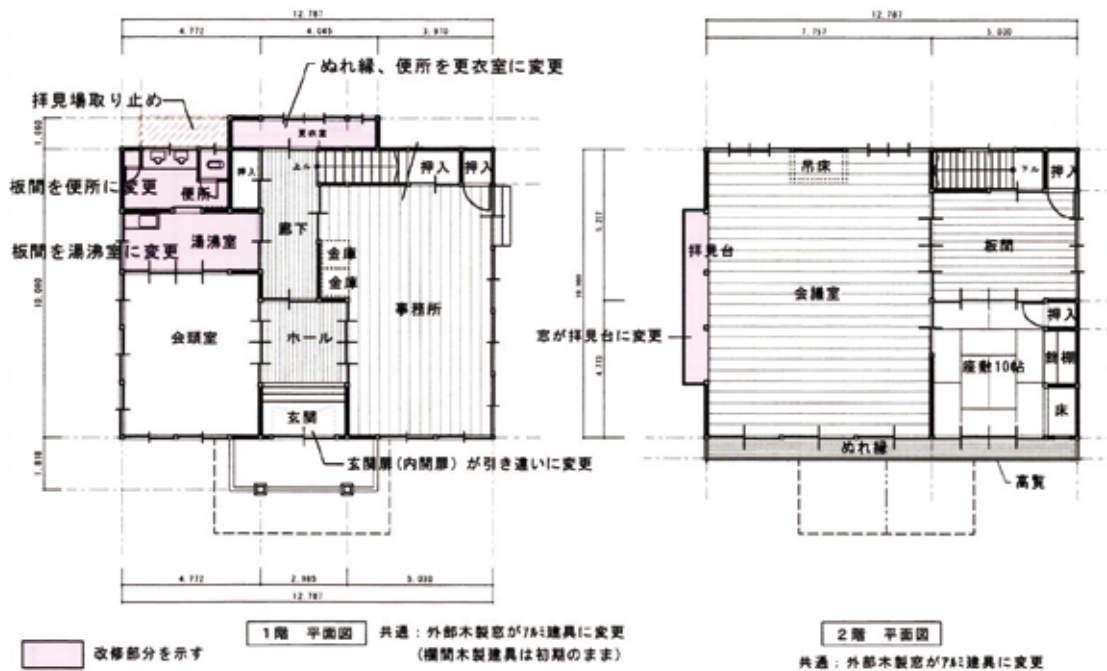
平成 17 年時平面図 (NEO 建築設計室)
